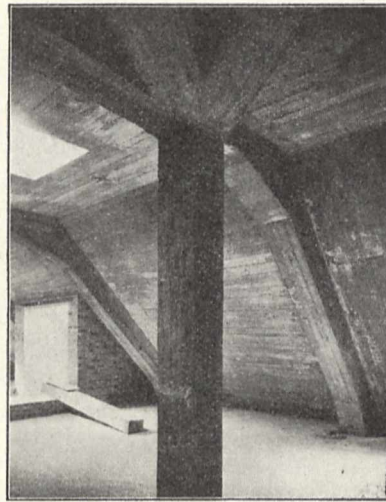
Knotenpunkt des Eisenbeton-Dachbinders.
